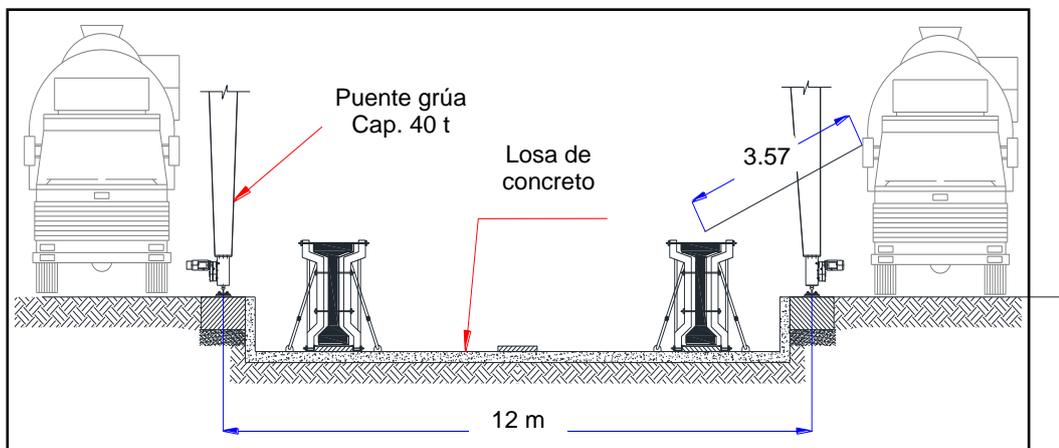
Mejora implementada en planta de prefabricados Tramo II. Esquema de línea de producción de vigas prefabricadas de  $H = 1.80$  m de altura implementando grúa tipo pórtico de 40 t.
